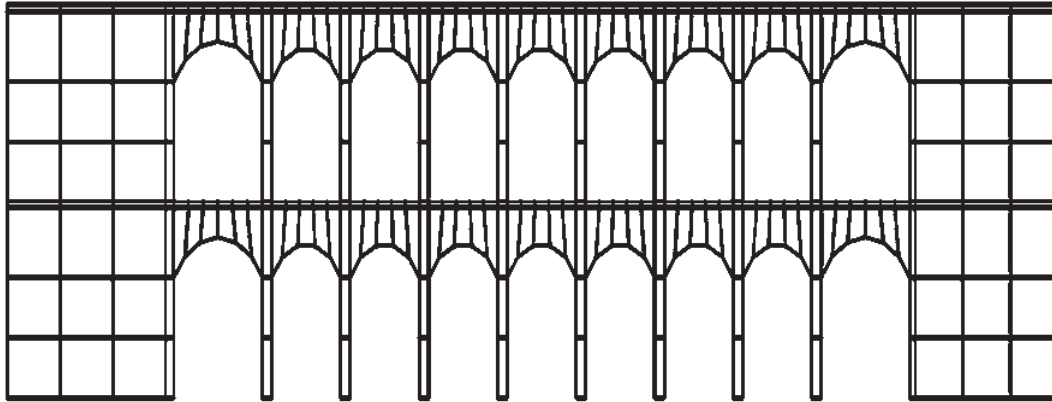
Modelo de elementos rígidos para la arcada sur del primer patio.
